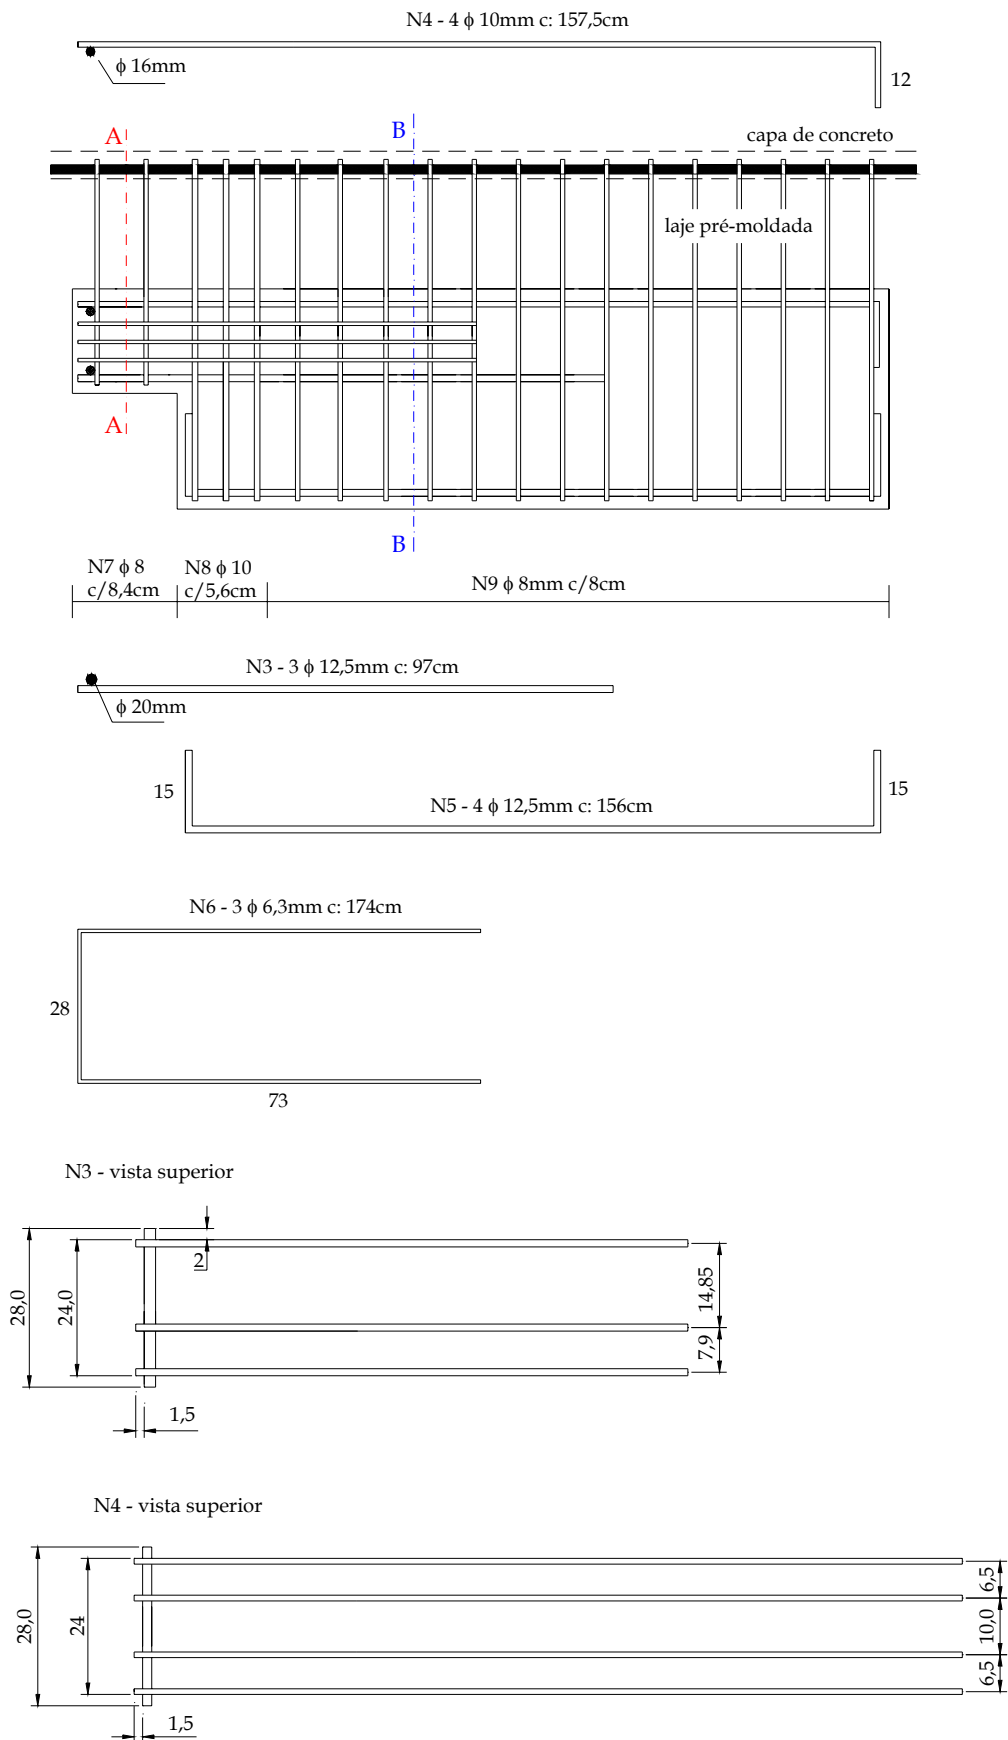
Armadura das vigas - parte 1 (dimensões em cm).
